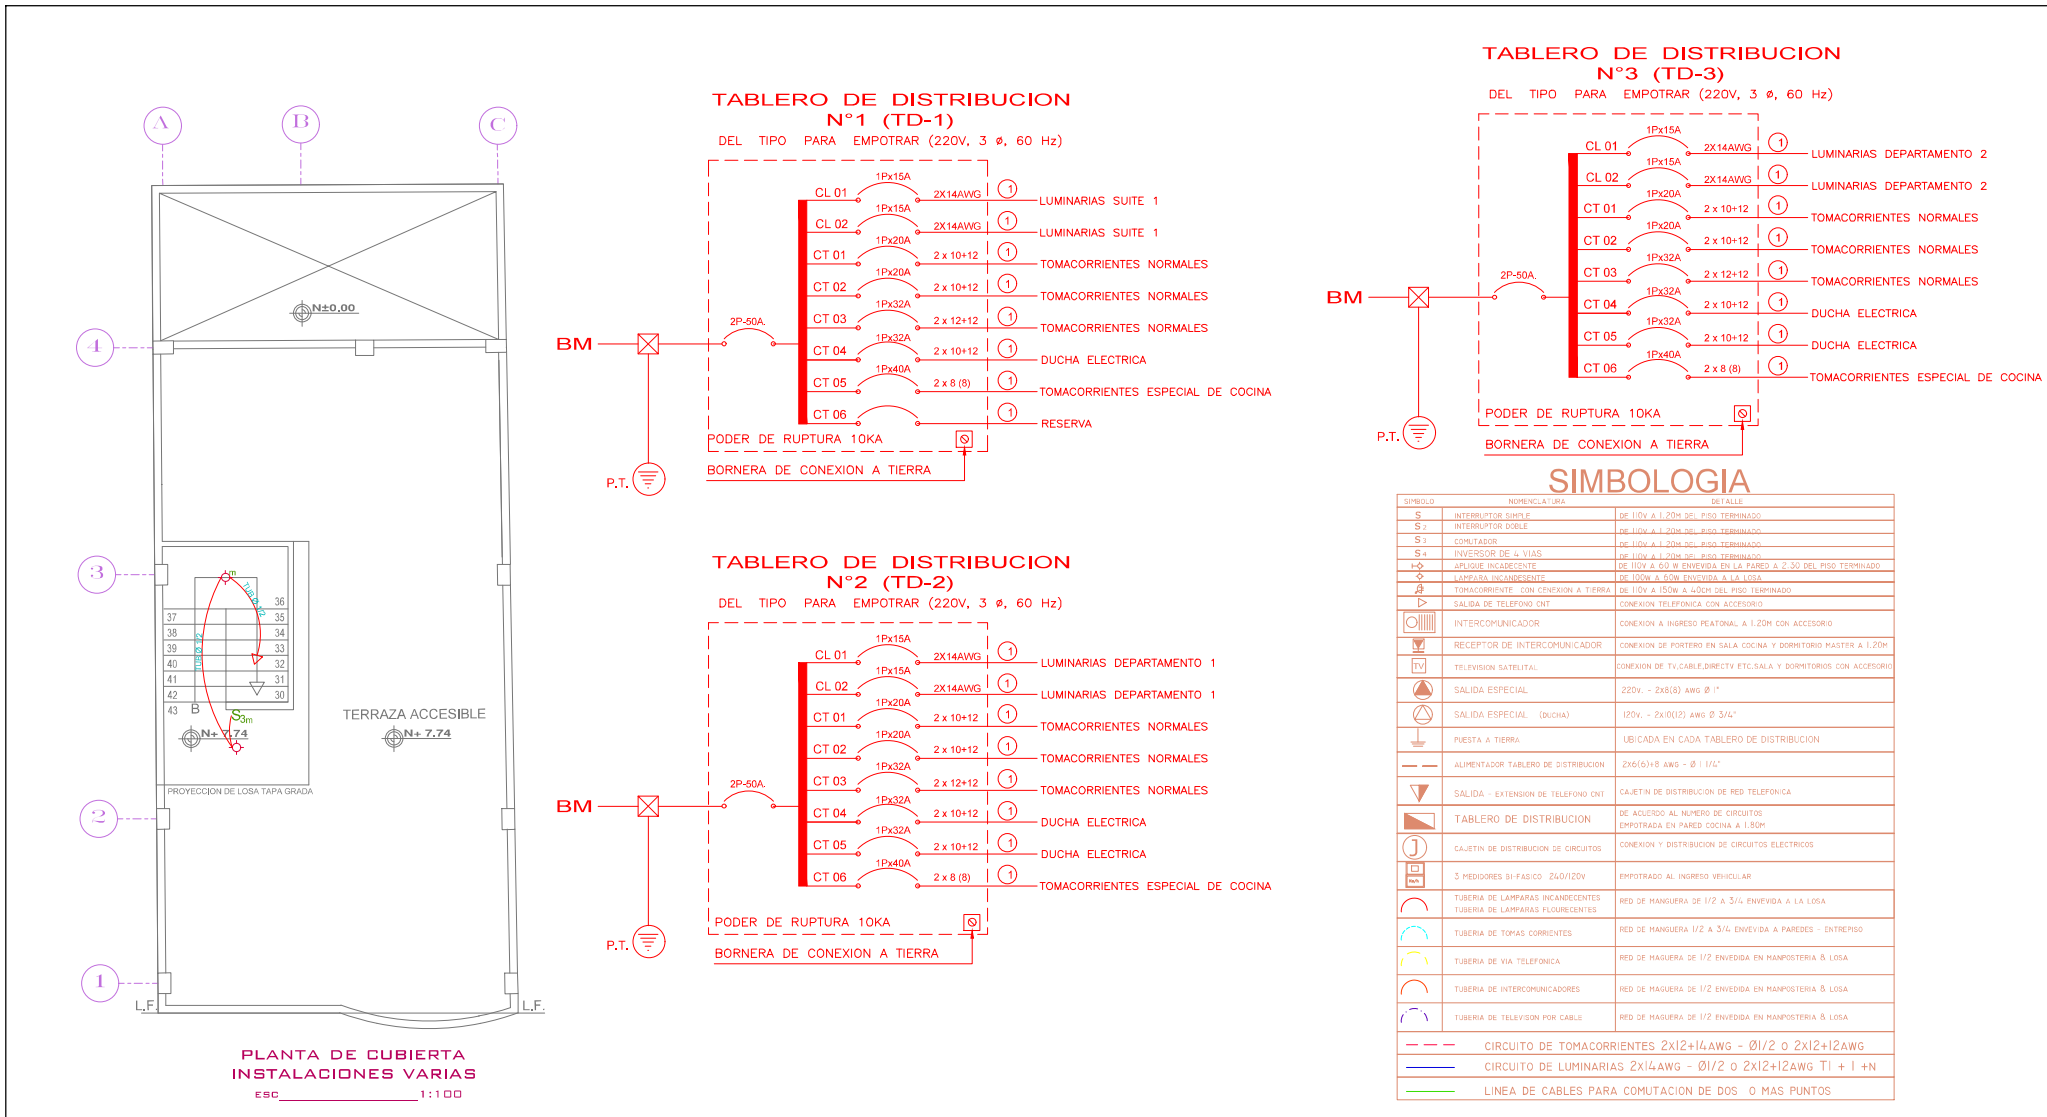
Tablero de distribución, simbología, planta de cubiertas del proyecto base.
